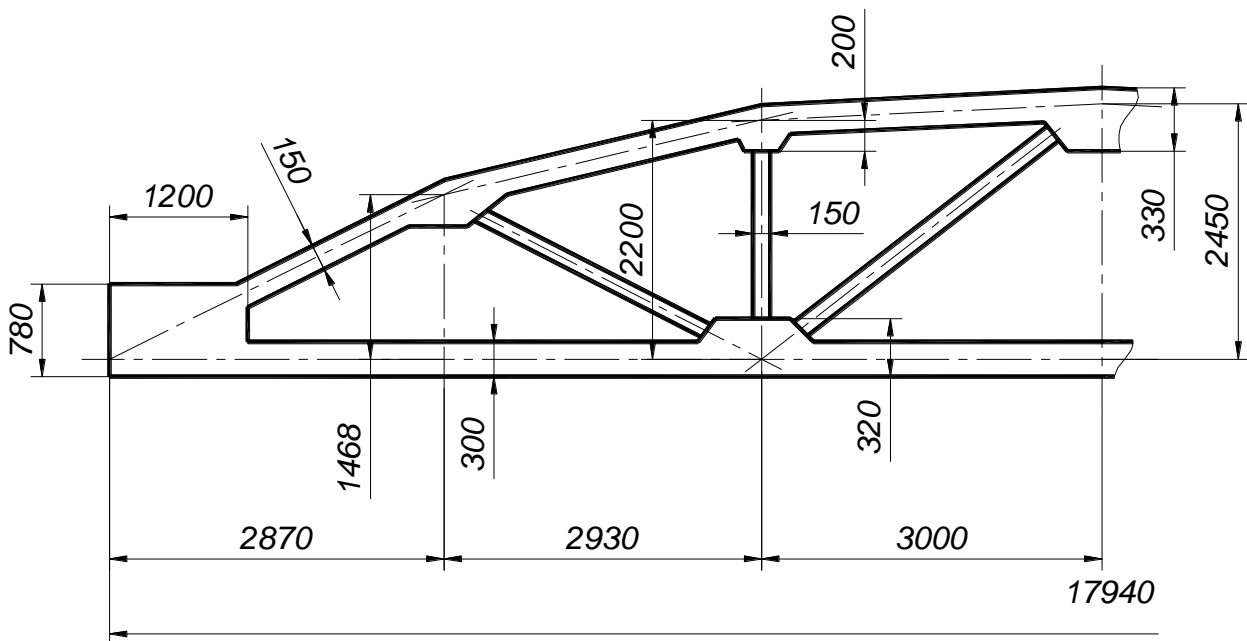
Уніфікована залізобетонна стропильна сегментна ферма для прольоту шириною 18 м
